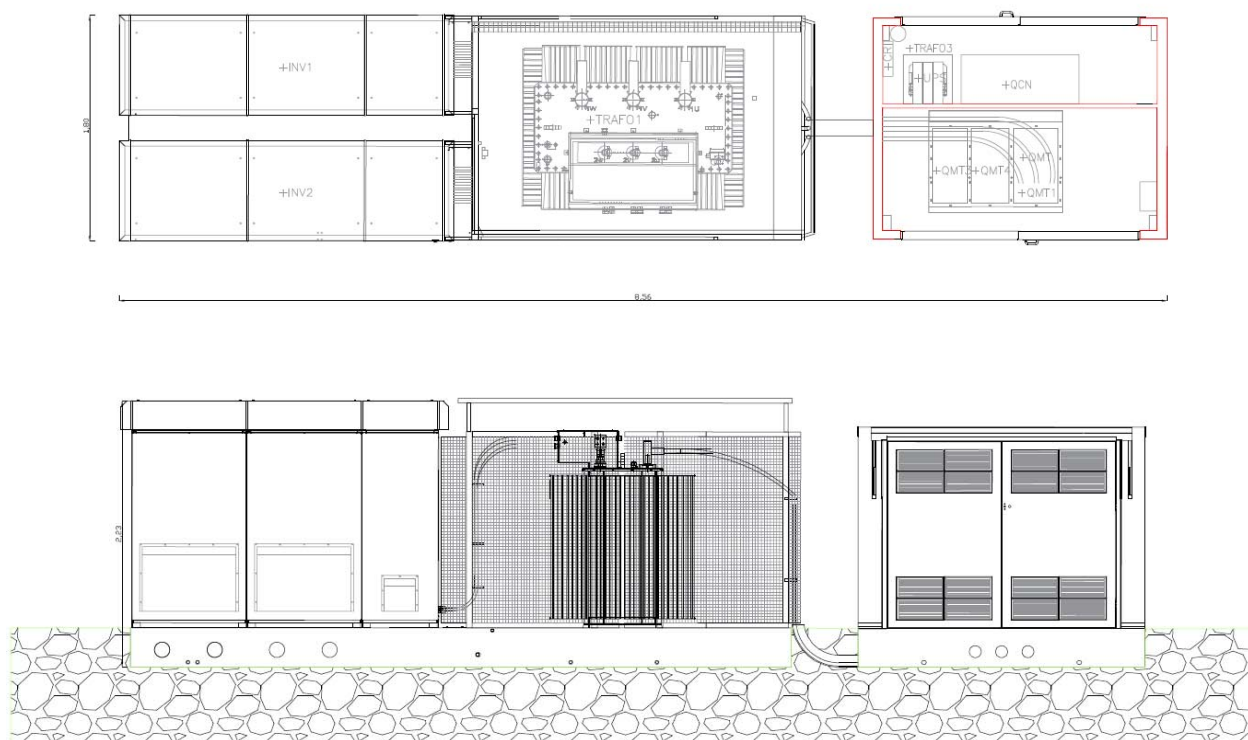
Pianta e prospetto cabina di trasformazione bt/MT
